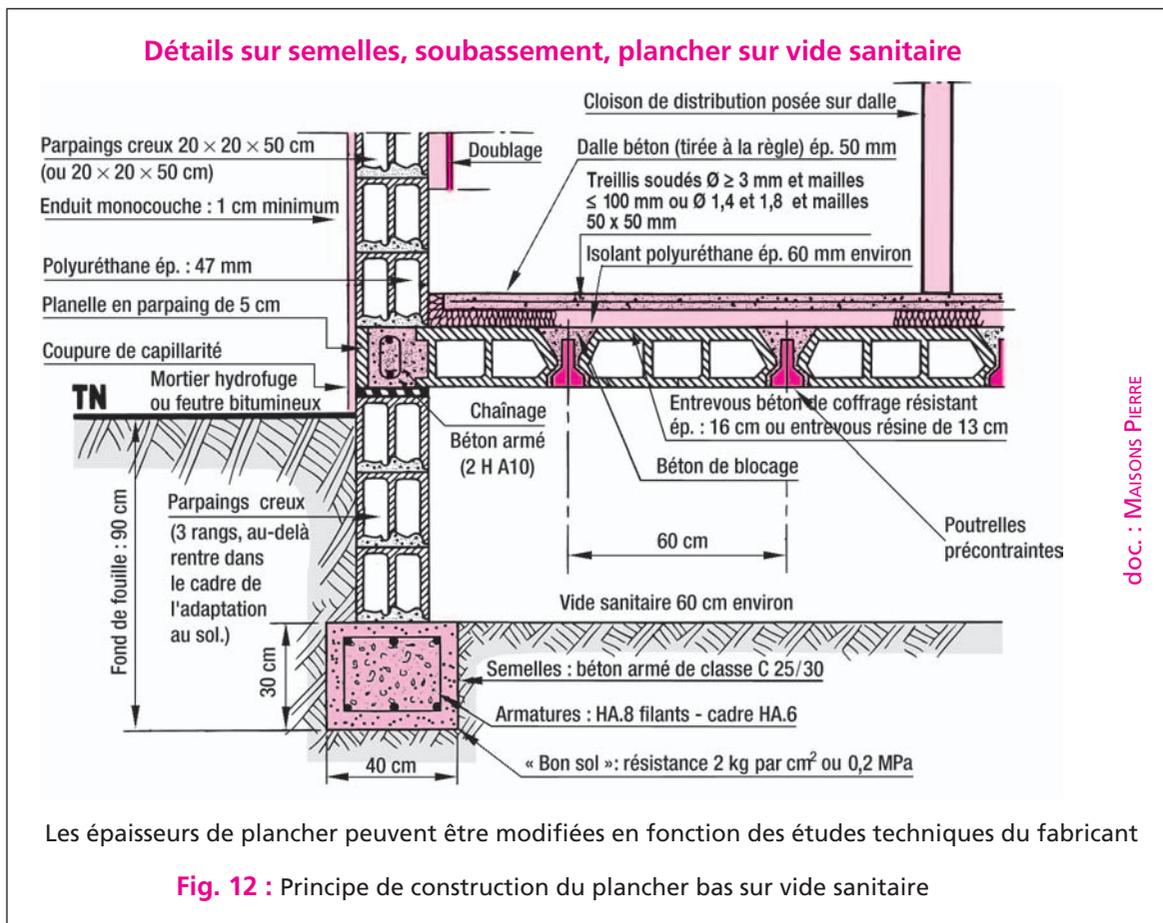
Principe de construction du plancher bas sur vide sanitaire
